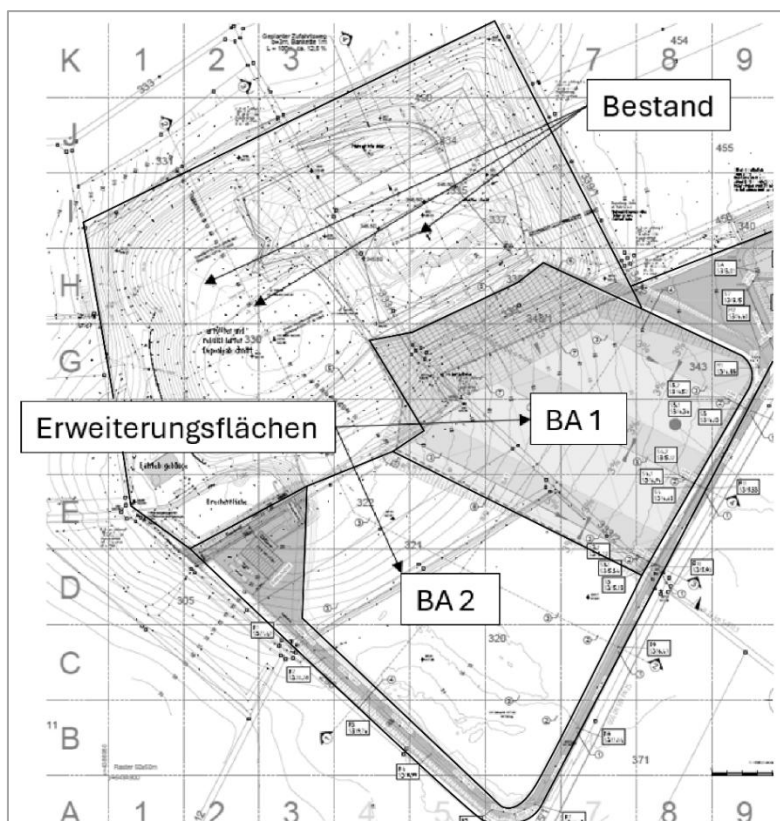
Lageplan mit Bestandsdeponie und Erweiterungsfläche (I1)
